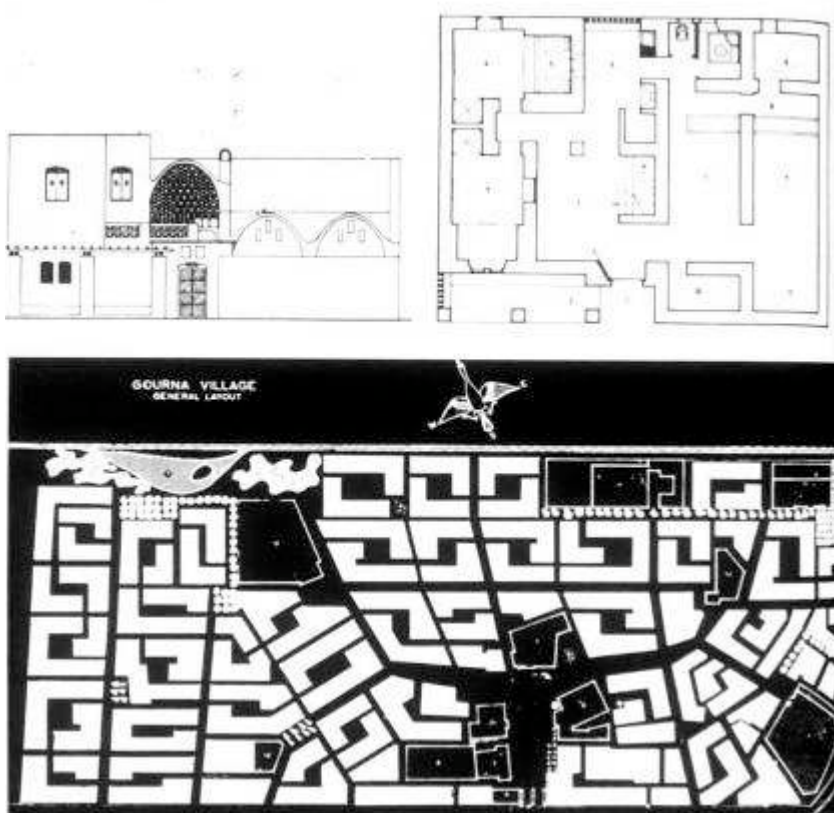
, Gournà Village di Hassan Fathy, planimetria, pianta e prospetto di un alloggio tipo
